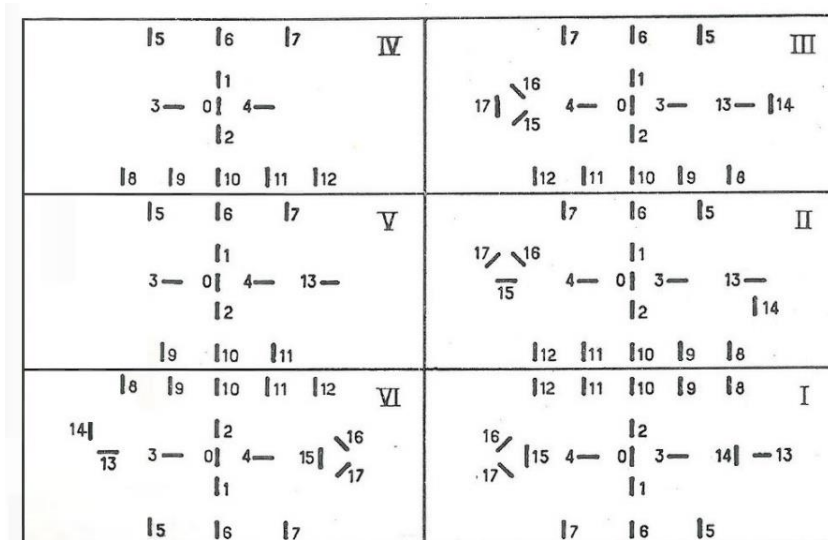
Position des jauges dans la configuration testée – Vue en plan
